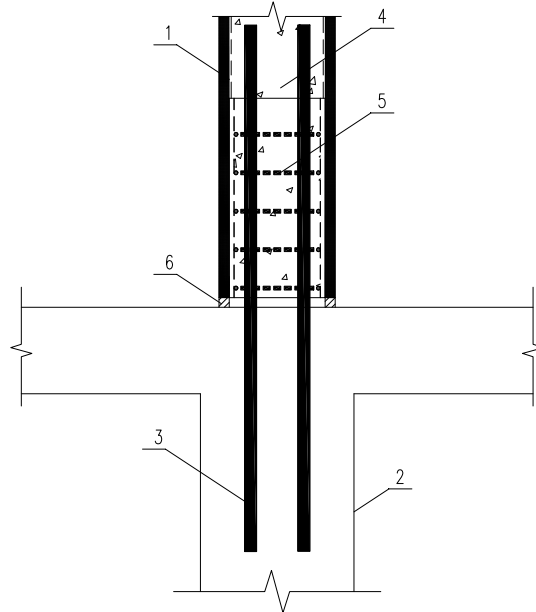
上层钢管混凝土柱与下层混凝土结构之间钢筋锚固连接构造
